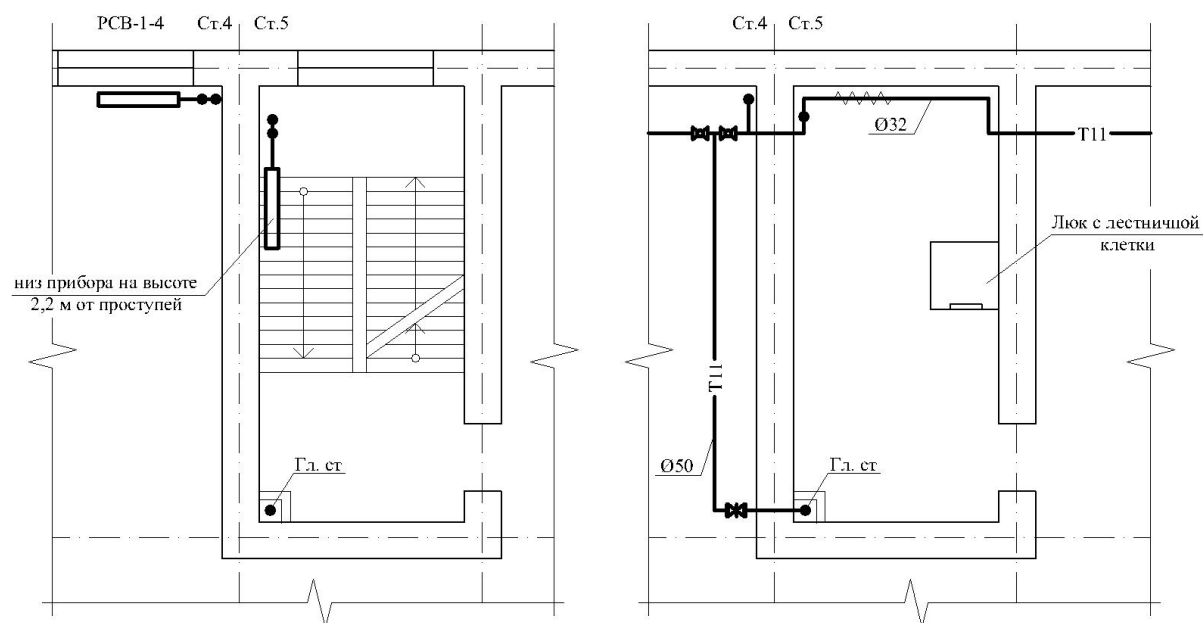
Вариант прокладки главного стояка: а – на типовом этаже; б – на чердаке
